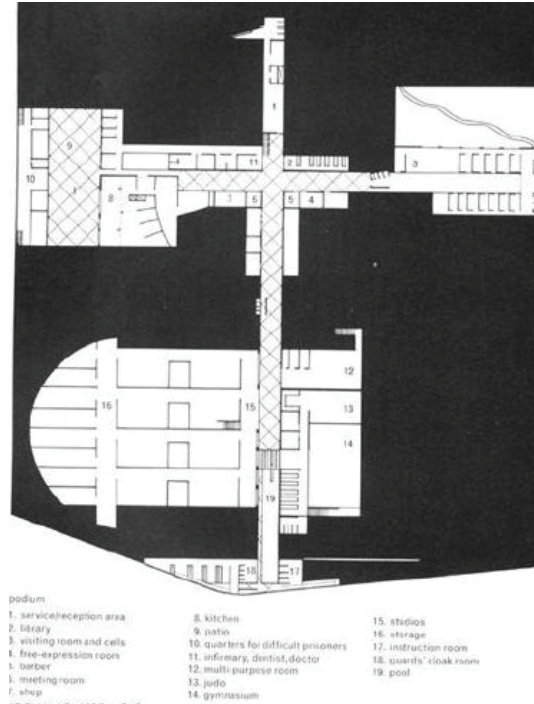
| Planta piso subterrâneo, Presídio de Koepel, Holanda
